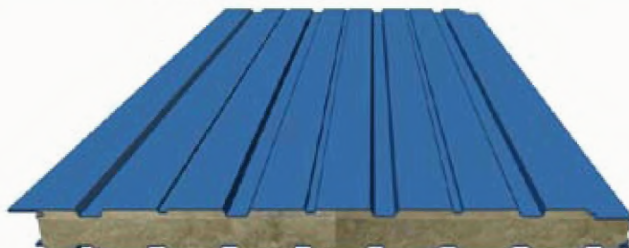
Панель трехслойная стеновая со скрытым креплением
